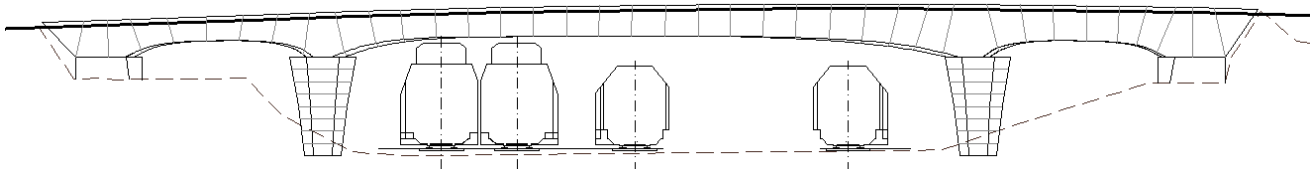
Figura VII: ALZADO DEL PUENTE VIGA DE HORMIGÓN
